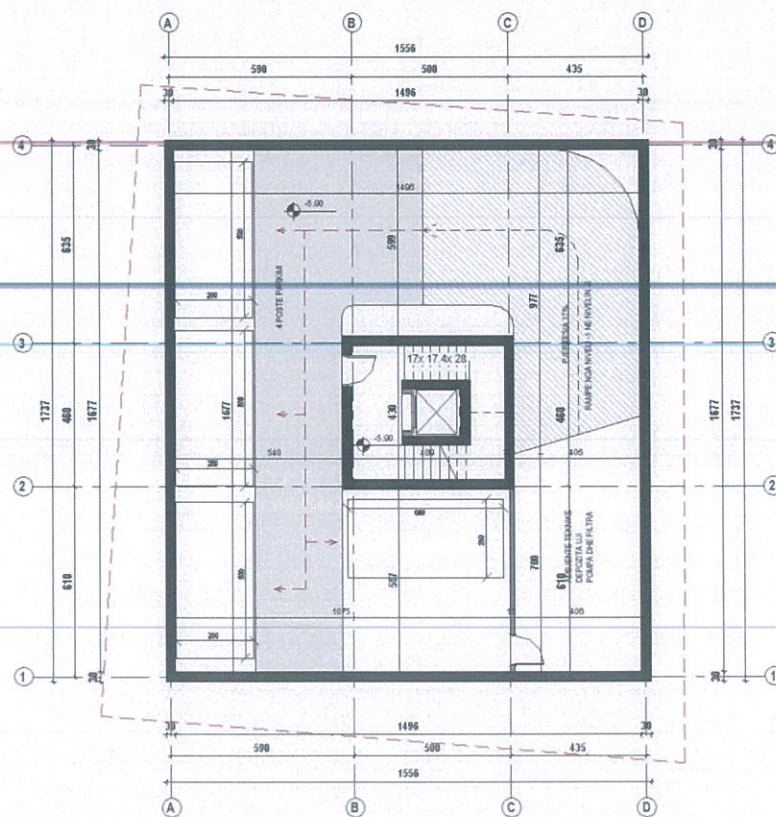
Planimetria e katit -2 me sipërfaqe 270.2 m² (parkim)
